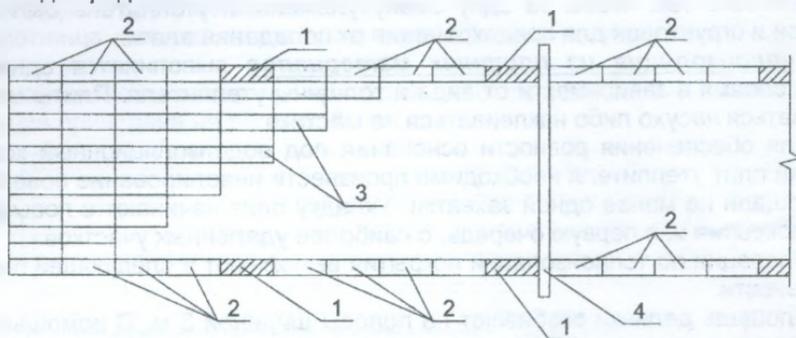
Последовательность укладки плитного утеплителя на захватке
